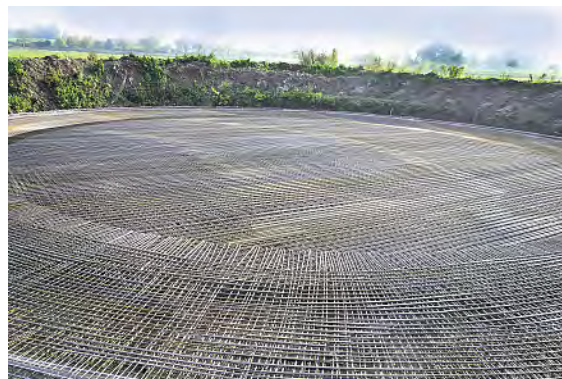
Bewehrung in der Bodenplatte eines Güllebehälters mit Pfahlgründung. Fotos (2): Hans-Jochim Rohweder
